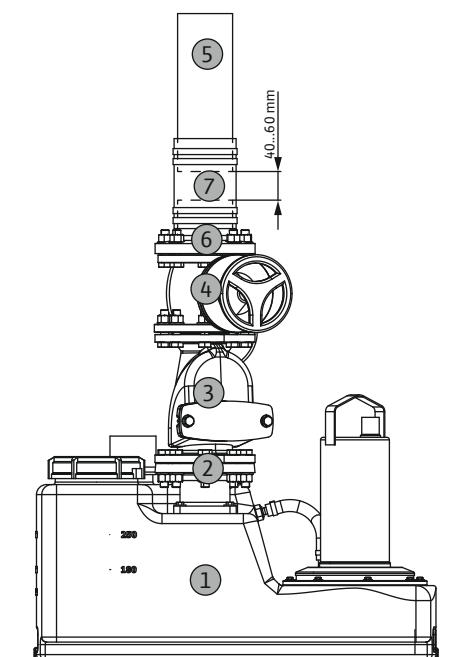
Монтаж під'єднання до напірного трубопроводу
